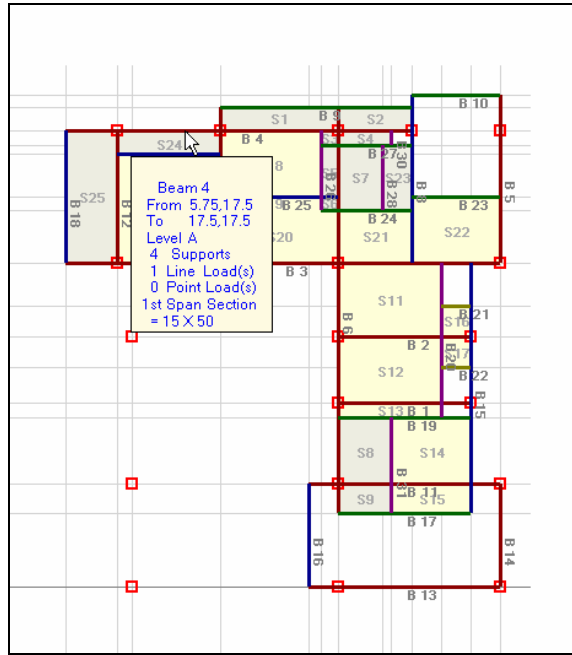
ปุ่มคำสั่ง Element Detail
